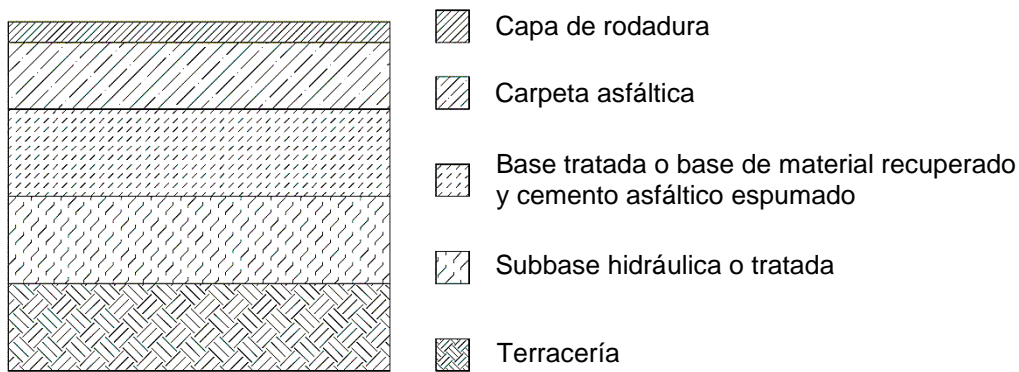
Sección transversal de un pavimento asfáltico semiflexible
